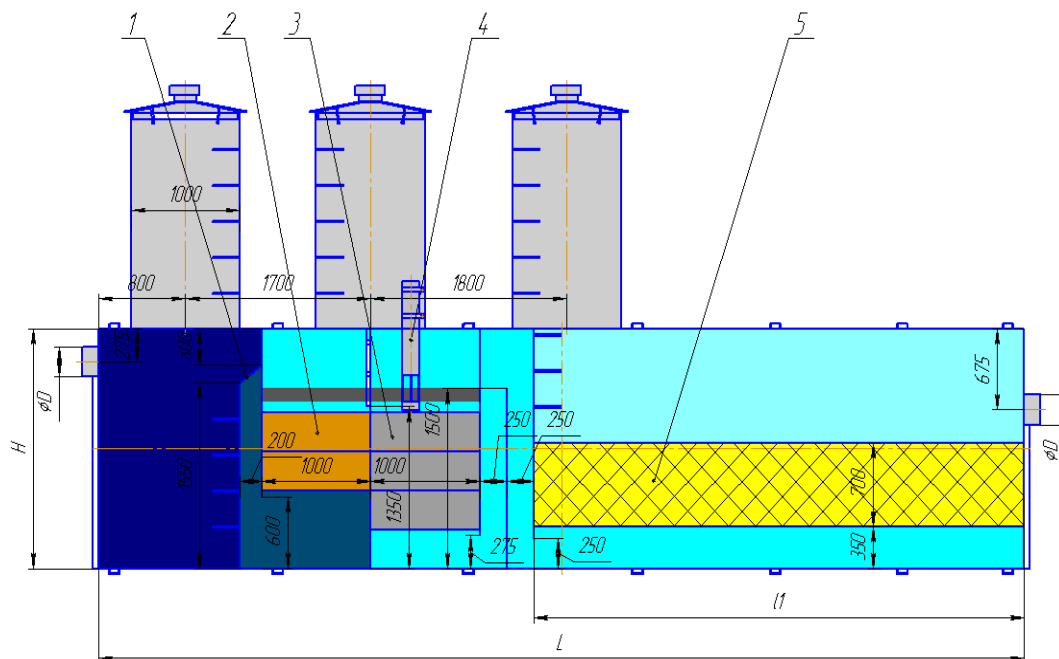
Очистные сооружения поверхностного стока в металлическом корпусе
